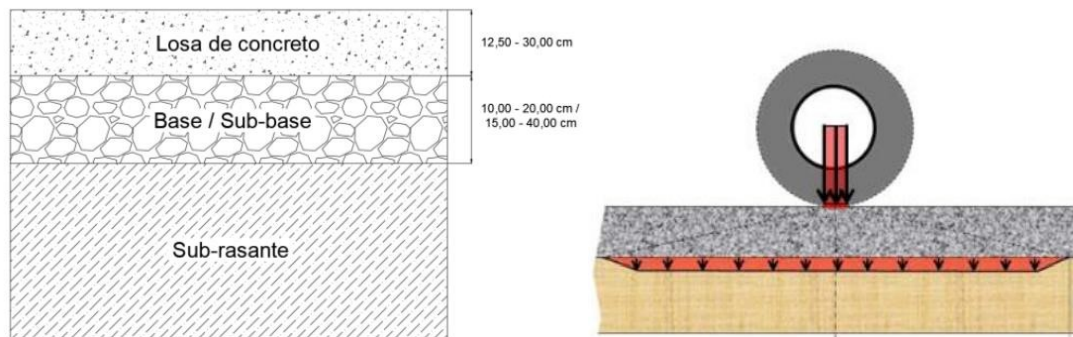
A. Estructura del pavimento rígido. B. Transmisión de cargas en pavimentos rígidos.
